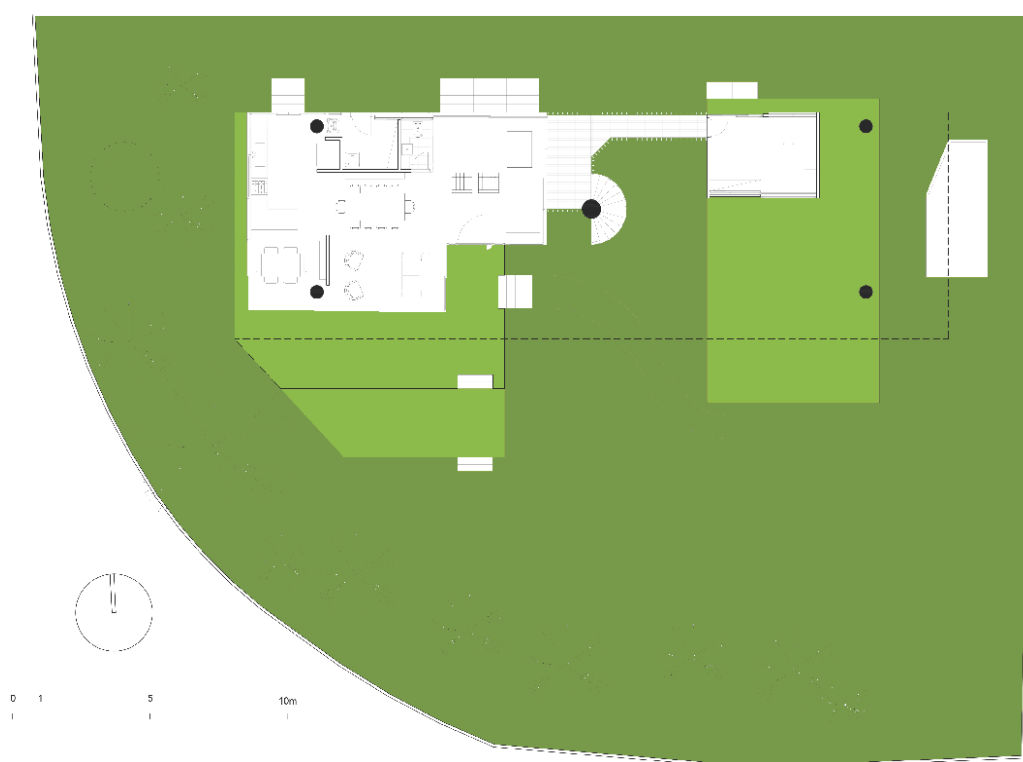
Planta do pavimento térreo. Fonte: AUTOR (2017).
